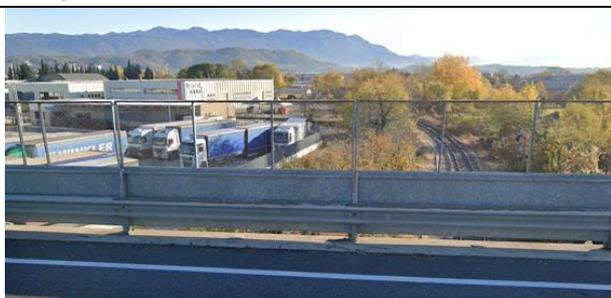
st: Vista da via Trieste, (in direzione est) sul cavalcaferrovia che attraversa la linea ferroviaria oggetto d'intervento.
